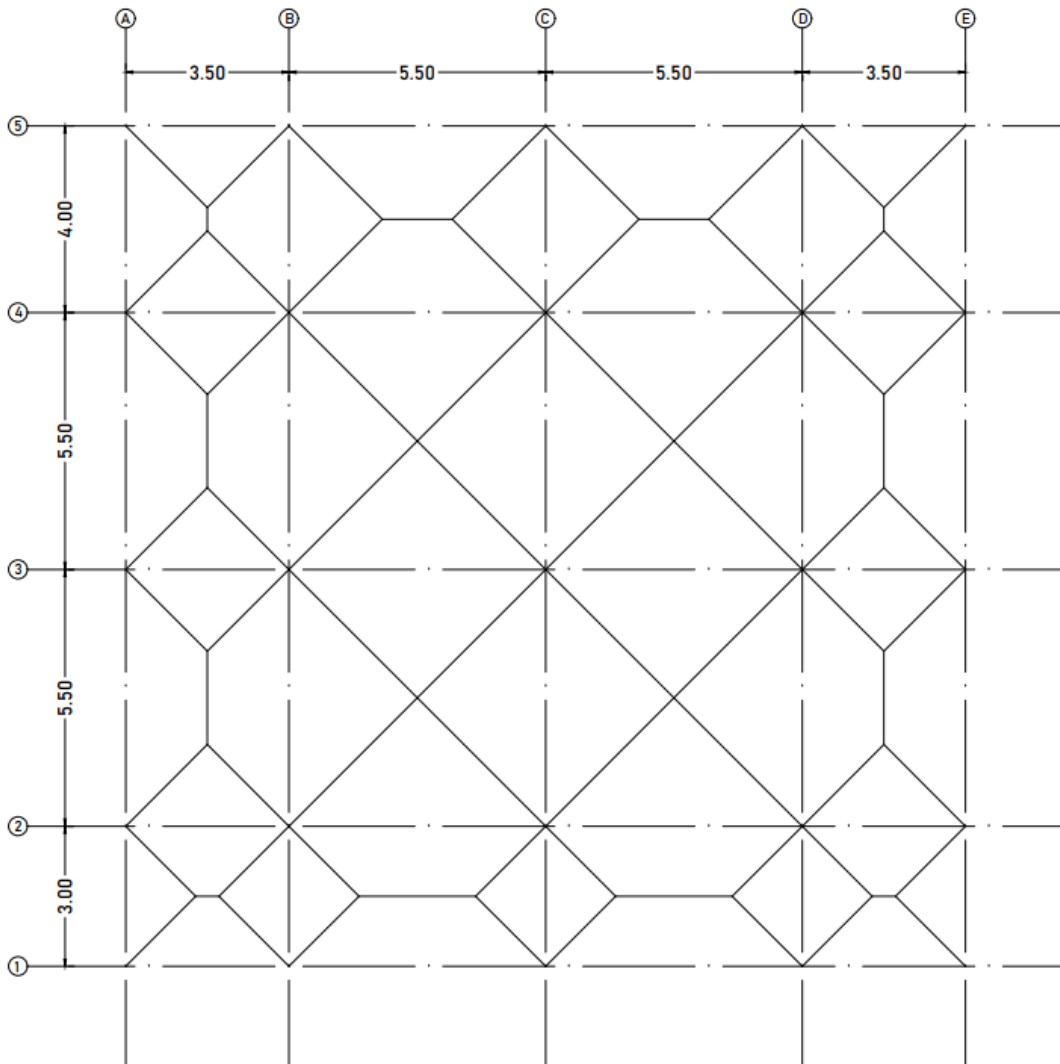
Distribución triangular y trapezoidal de cargas sobre las vigas de la losa tipo.
